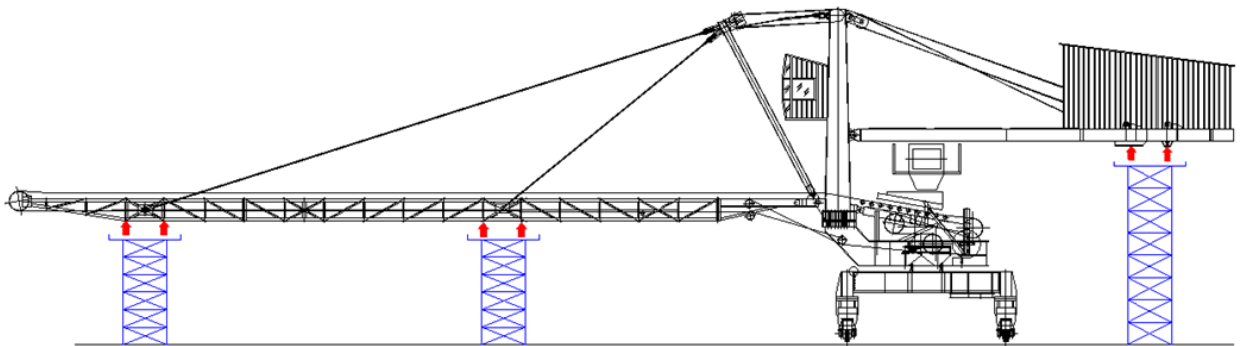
Parte do procedimento de instalação de reforços estruturais – macaqueamento da máquina para alívio de tensões.
